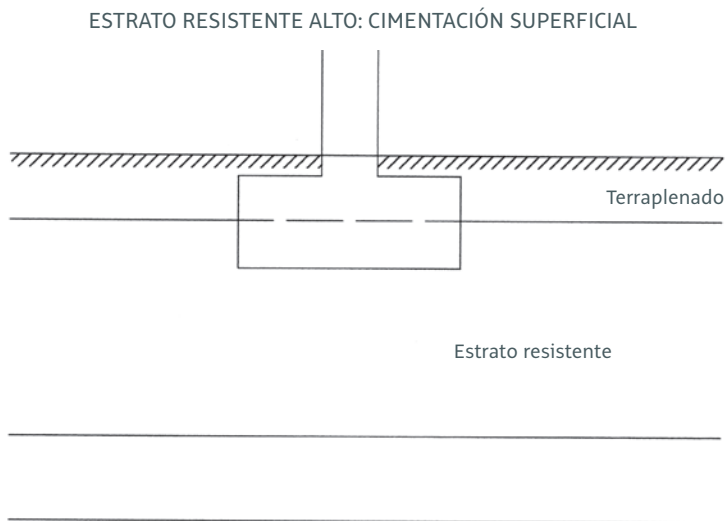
Si el estrato resistente se halla cerca de la superficie, por lo general podrá construirse una cimentación superficial
